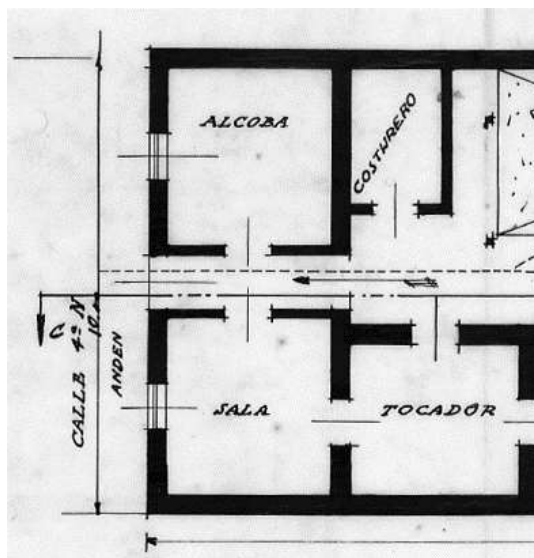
Planta alzada de viviendas realizadas en los años 30 y 40.
